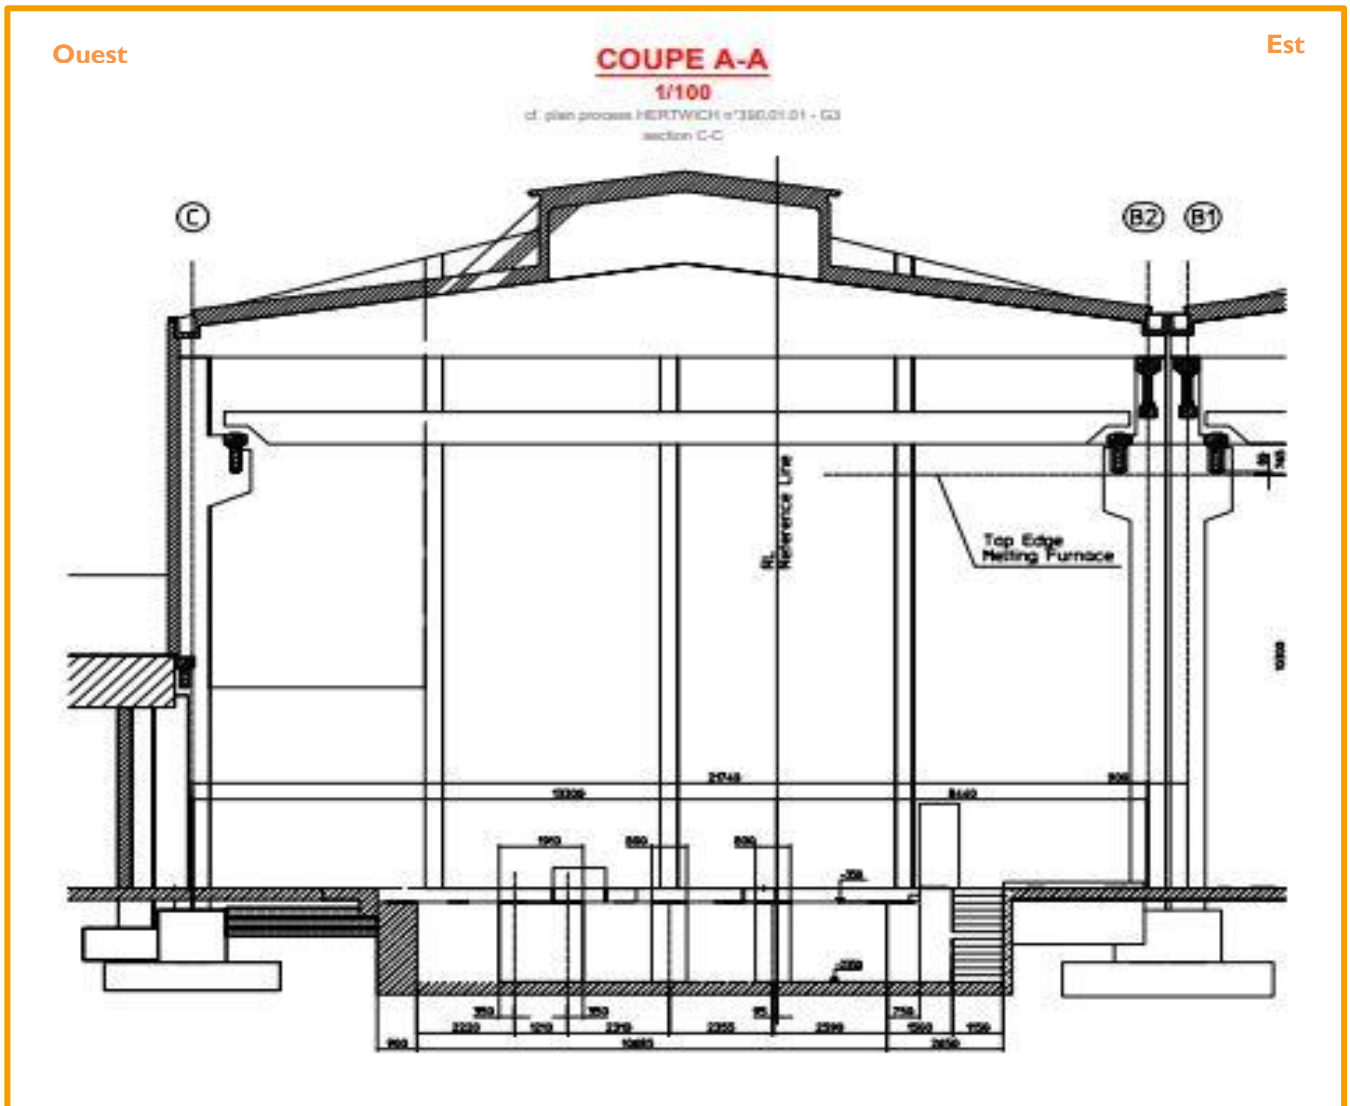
Plan de coupe du projet d'aménagement (source : Cahier des charges en date du 08/11/2022)
